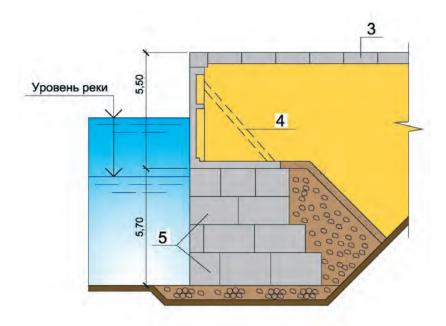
Конструкция причального сооружения из массивной кладки с надстройкой: 3 — бетонное покрытие; 4 — уголковая надстройка из сборного железобетона; 5 — бетонные массивы
